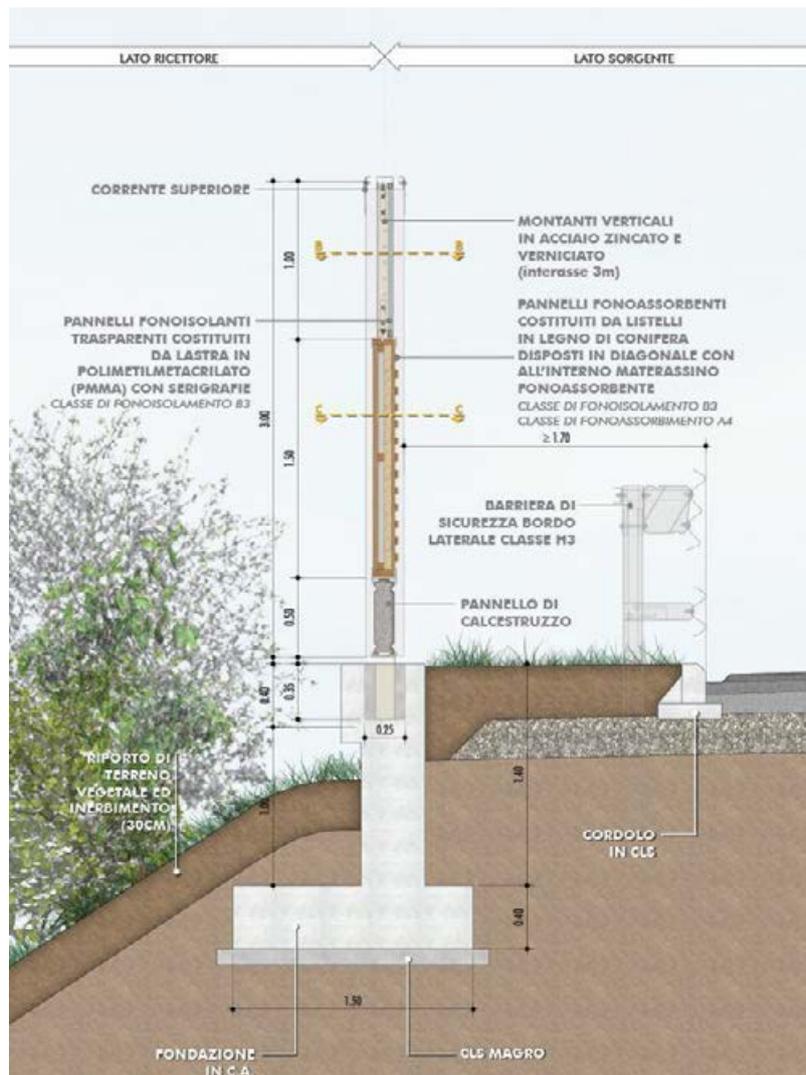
SEZIONE TIPOLOGICA SU RILEVATO
